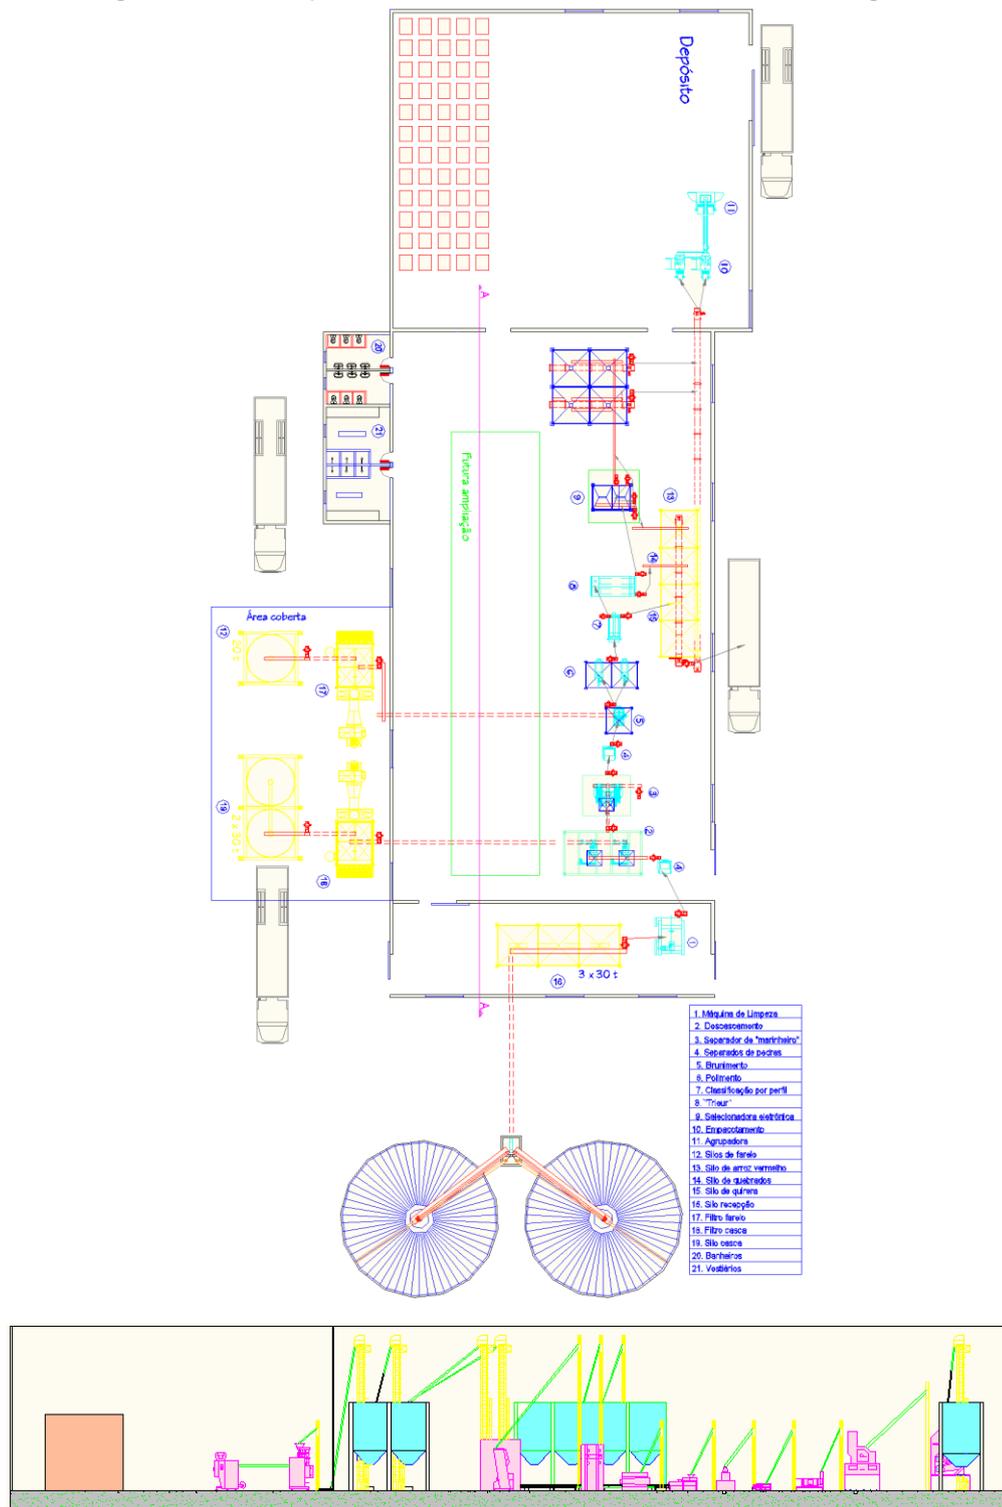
Planta baixa e corte da Unidade de beneficiamento de arroz
